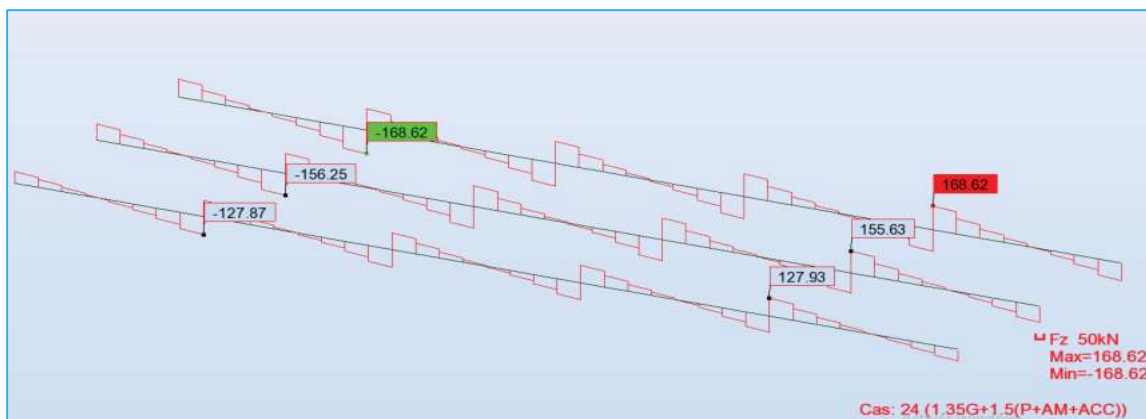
Effort Tranchant F_z en KN au niveau des poutres longitudinales
